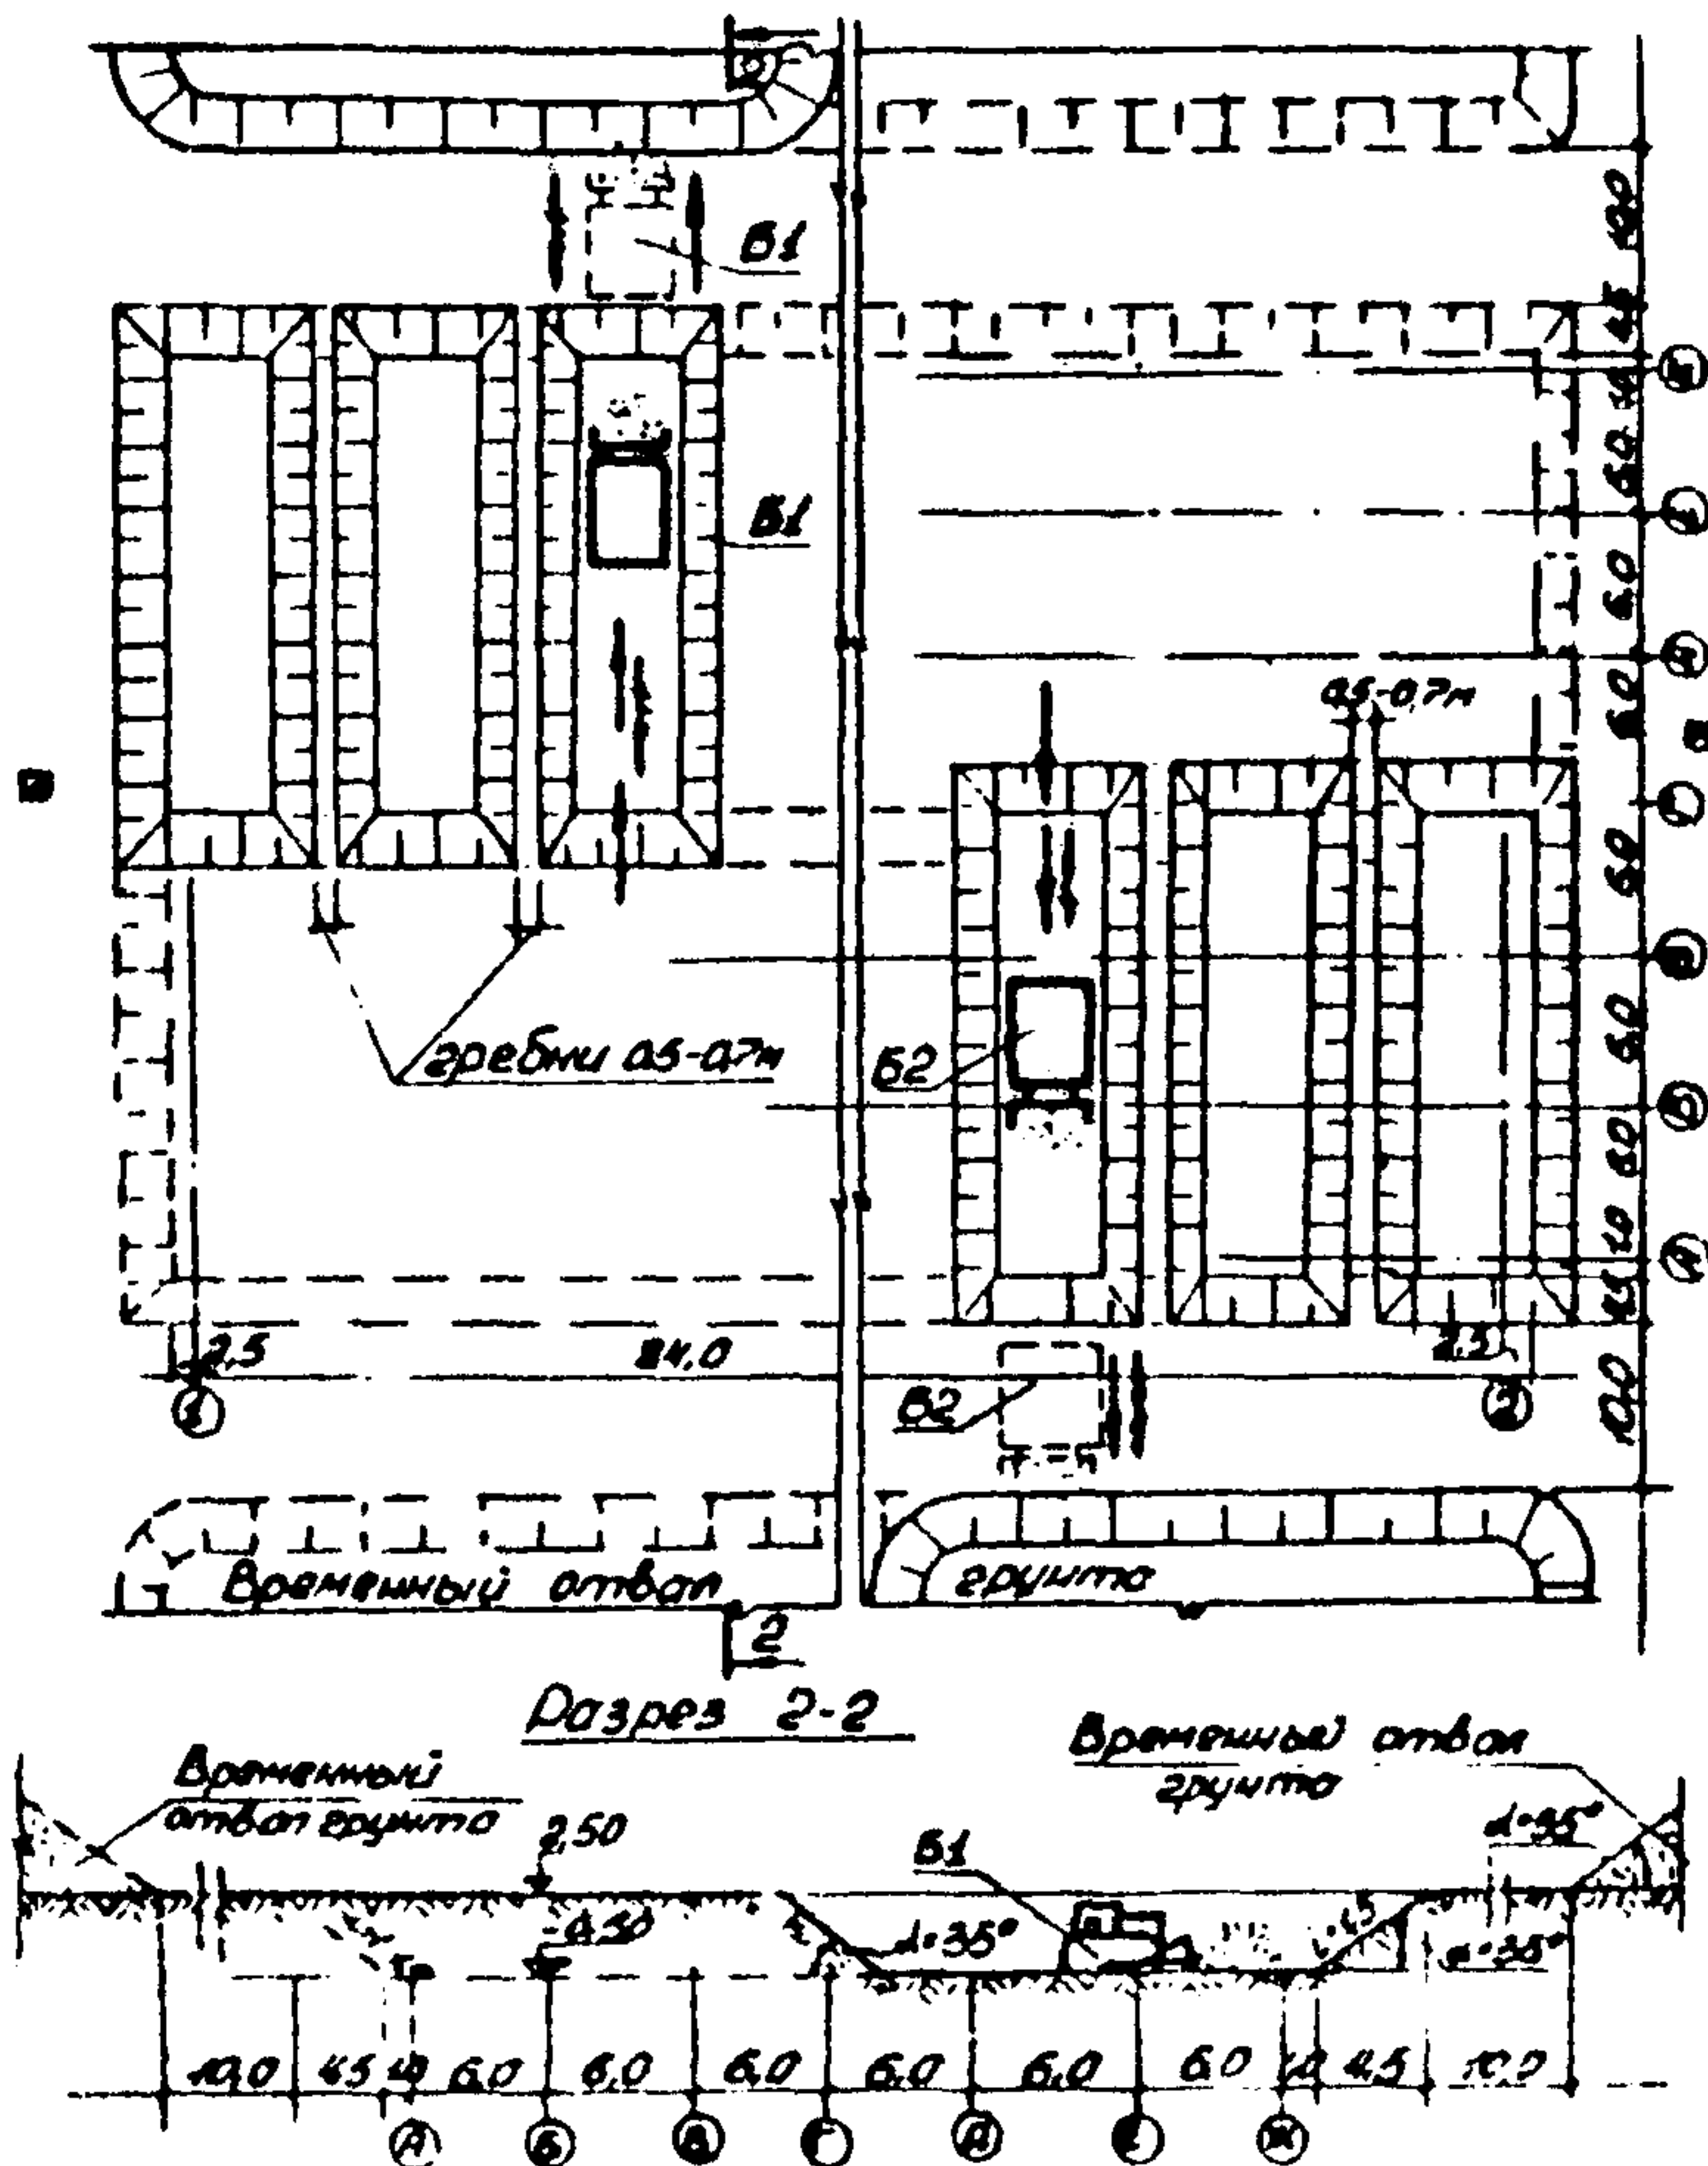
Схема разработки и перемещения грунта траншейным способом:
